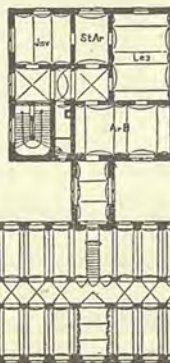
a, b, c*. — Archivio di Stato nelle prov. Westfalen a Münster (arch. Endell, Baltzer, Rattey).
